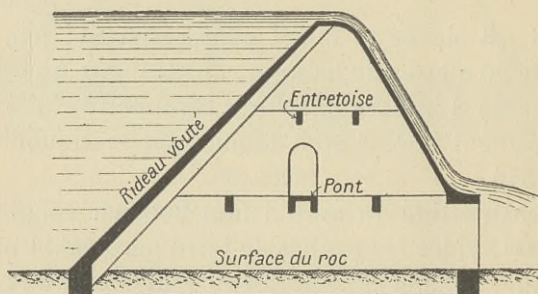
Coupe d'un barrage partiellement ouvert.
